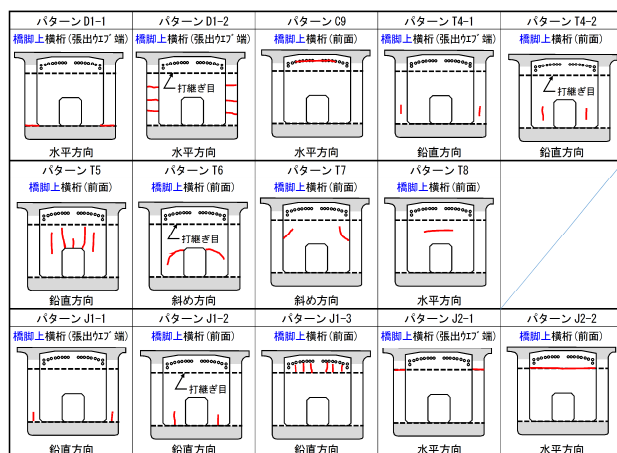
ひび割れパターン(支点上横桁:橋脚部)
